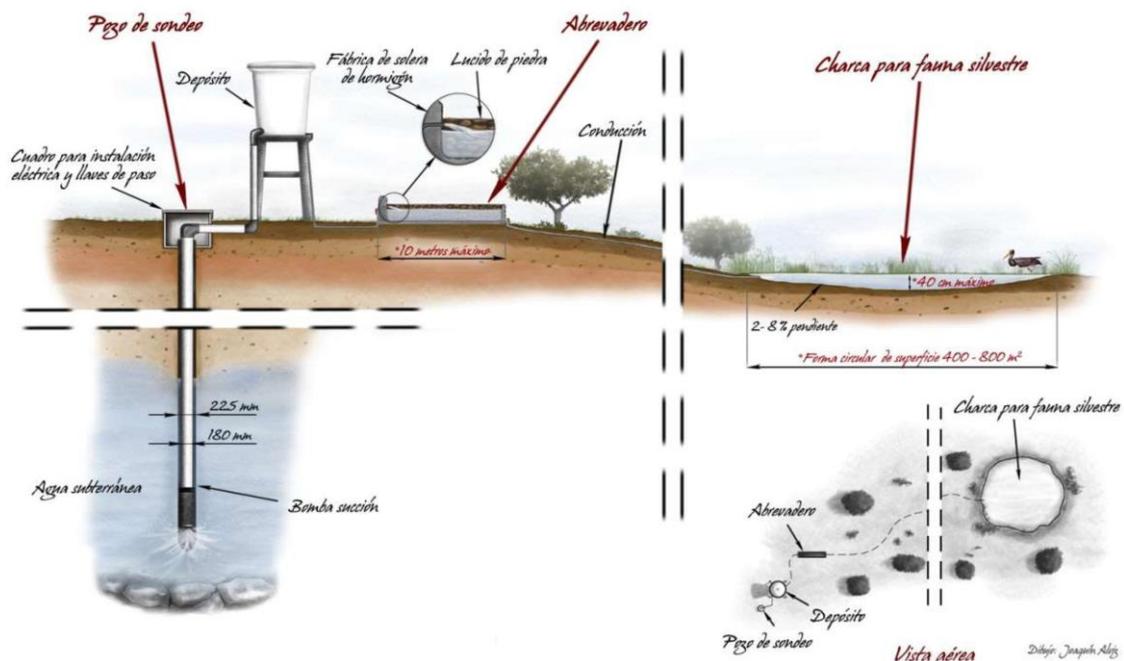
Pozo con abrevadero y charca Fuente: Junta de Extremadura (extremambiente)
